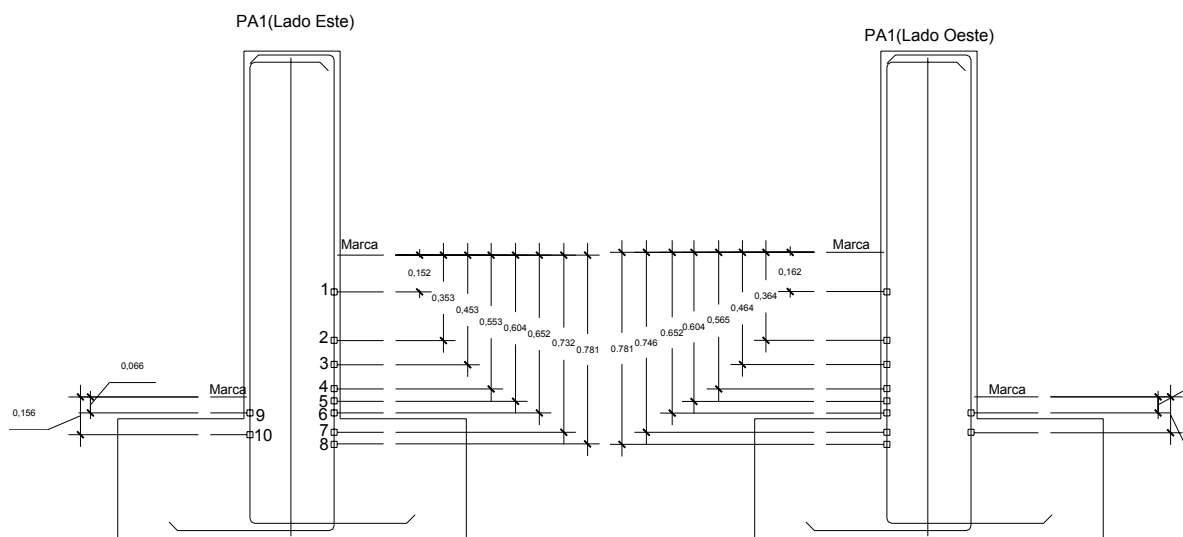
Instrumentação da armadura longitudinal dos modelos PA1.
